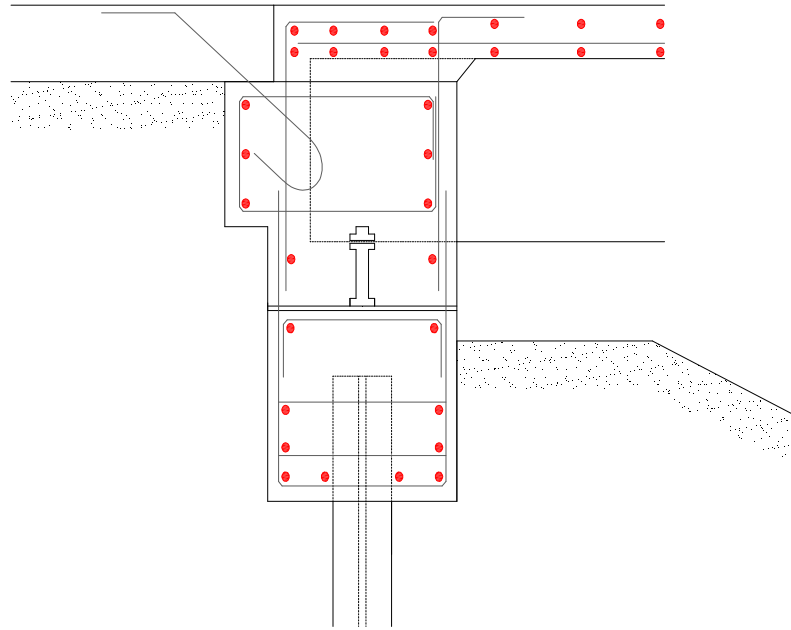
Connessione sovrastruttura – spalla, *schema 4
